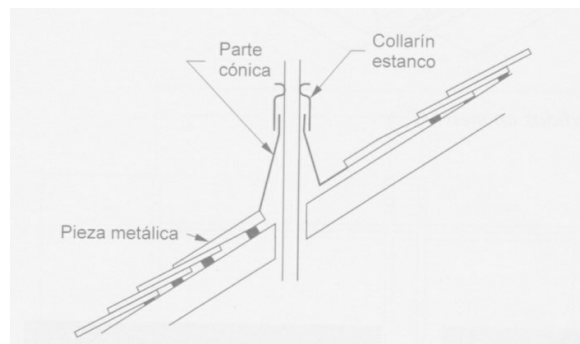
Esquema de cómo atravesar un tejado inclinado de techumbre de pizarra o de teja plana para efectuar la fijación de la estructura en los elementos resistentes bajo el mismo (fuente: CENSOLAR)
